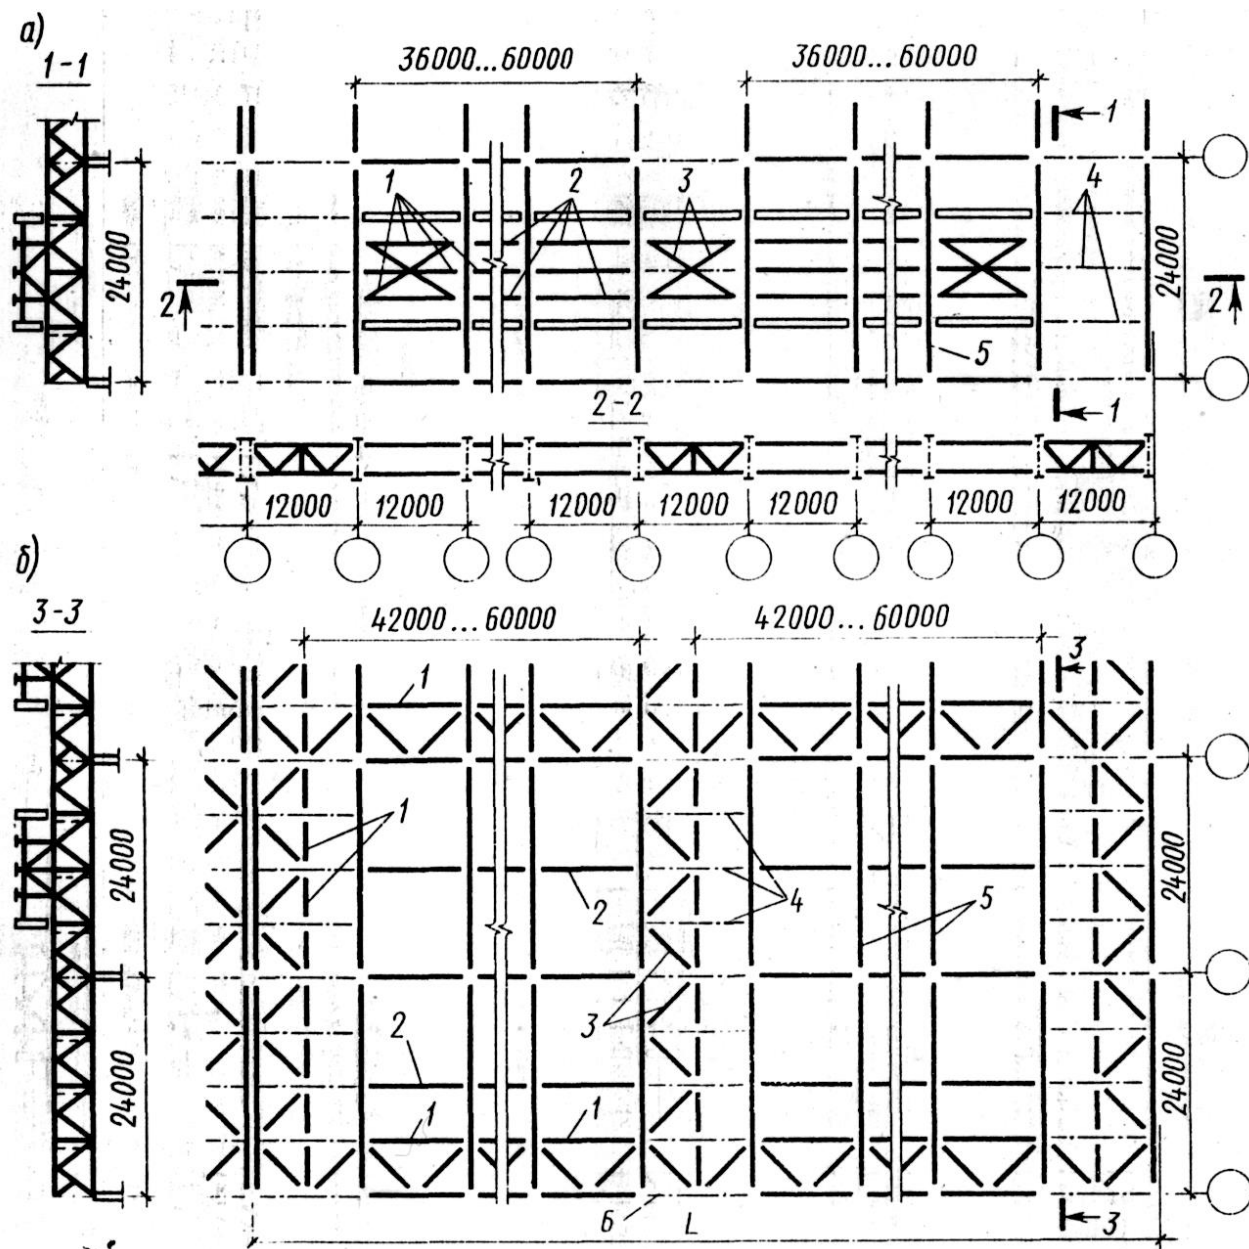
Связи по стропильным стальным фермам покрытия:
